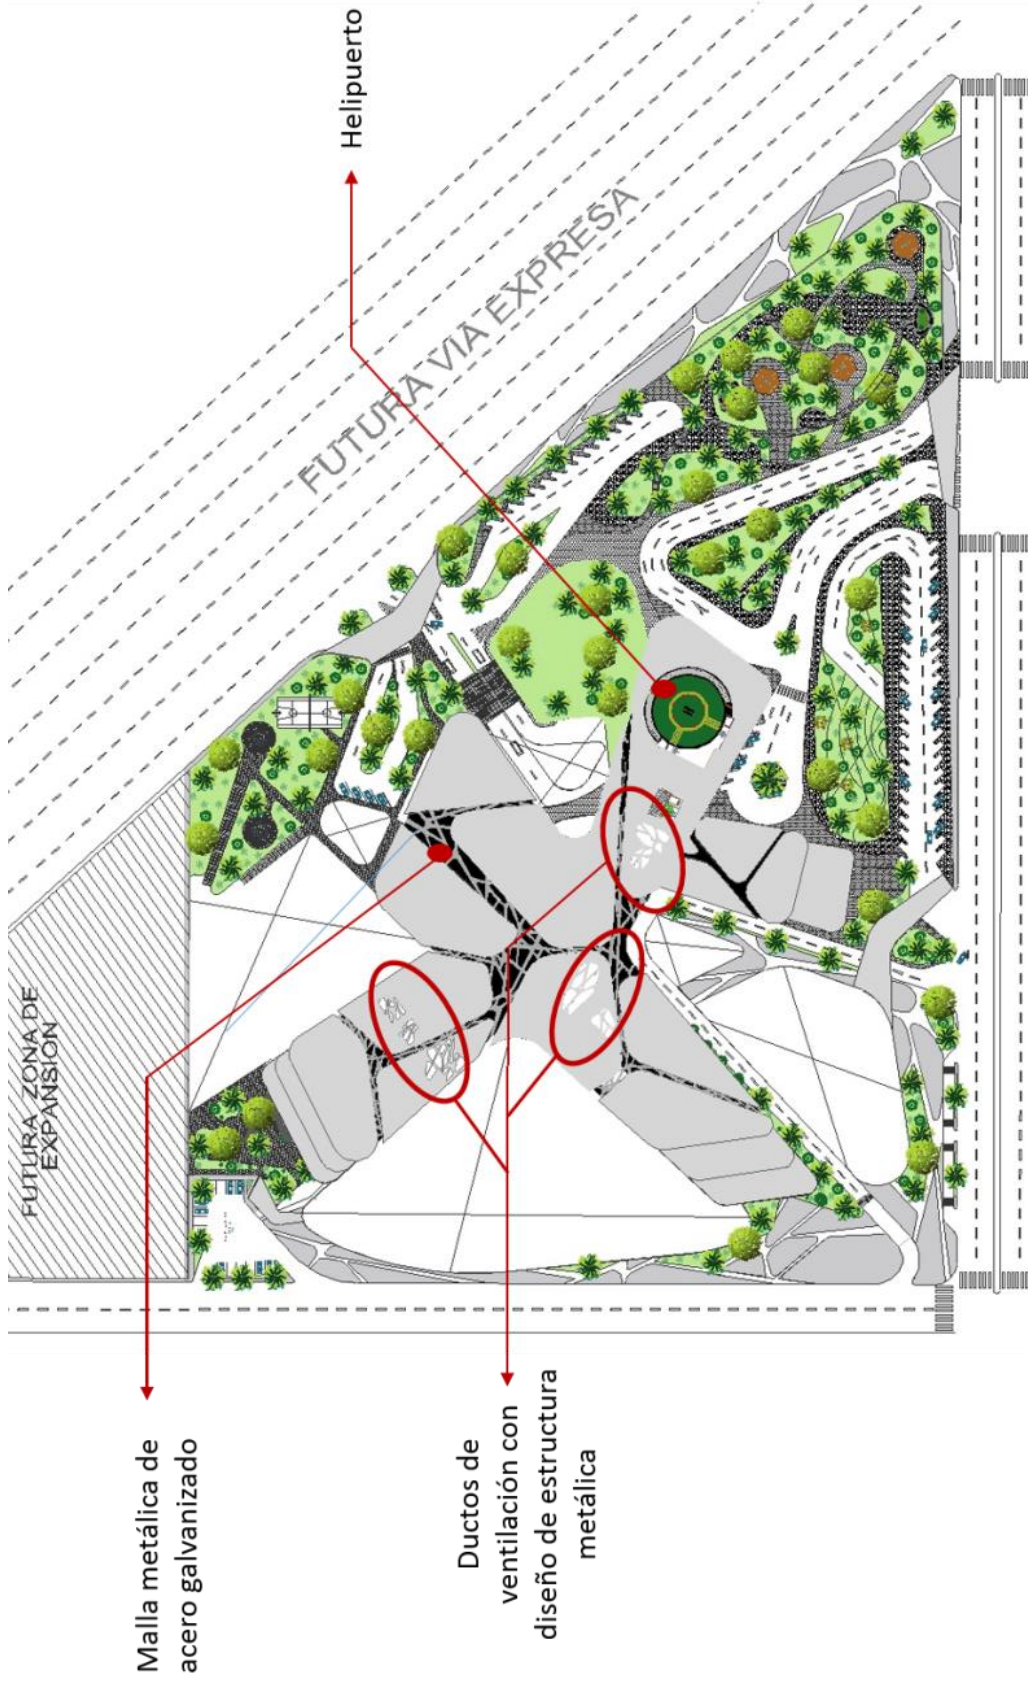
Zonificación Plano de Techos de la Propuesta Arquitectónica.
